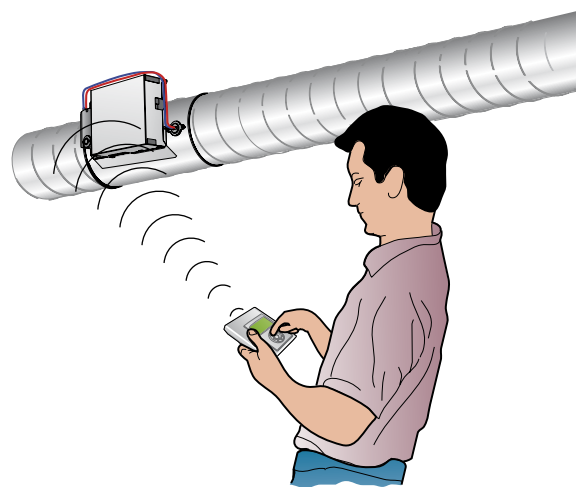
Беспроводное подключение TUNE Control с заслонкой CONTROL Da. В варианте для помещения (с CONTROL Db) монтируется на стене
